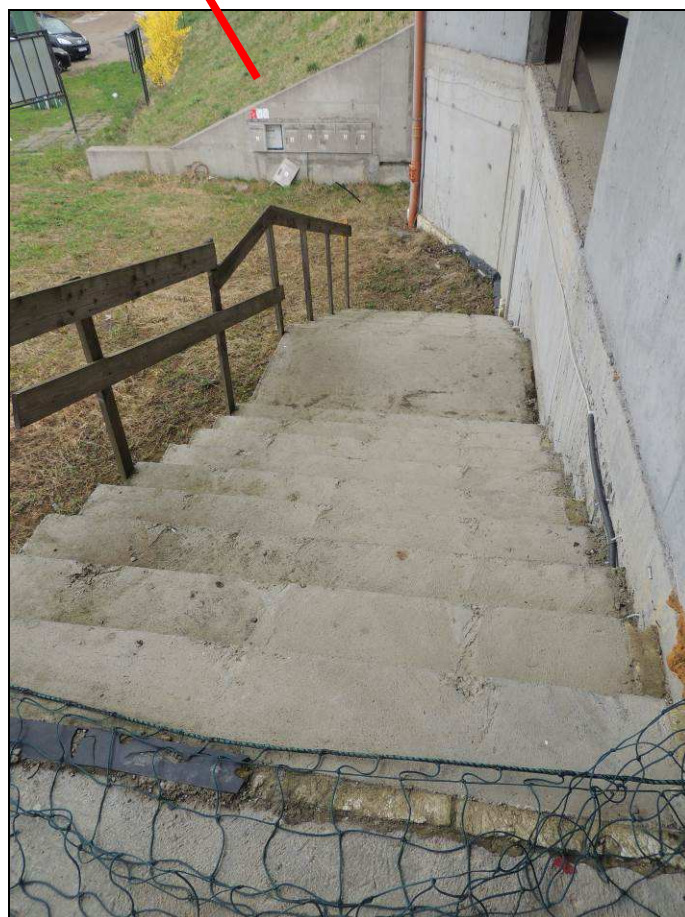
Widok elewacji fragmentu elewacji północno-wschodniej (elewacja boczna).
